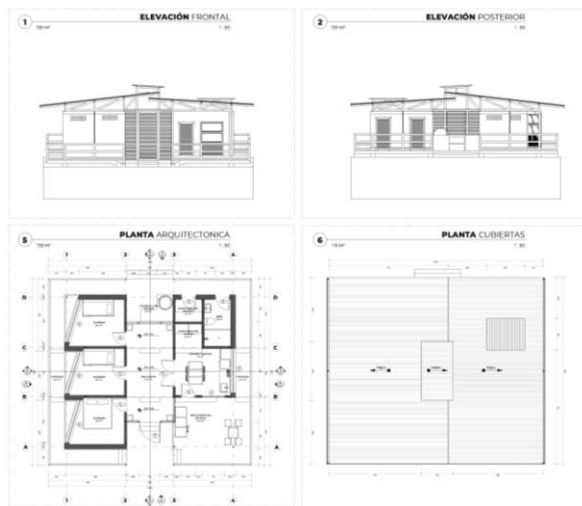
Planimetría Vivienda VRCPP Fase I
